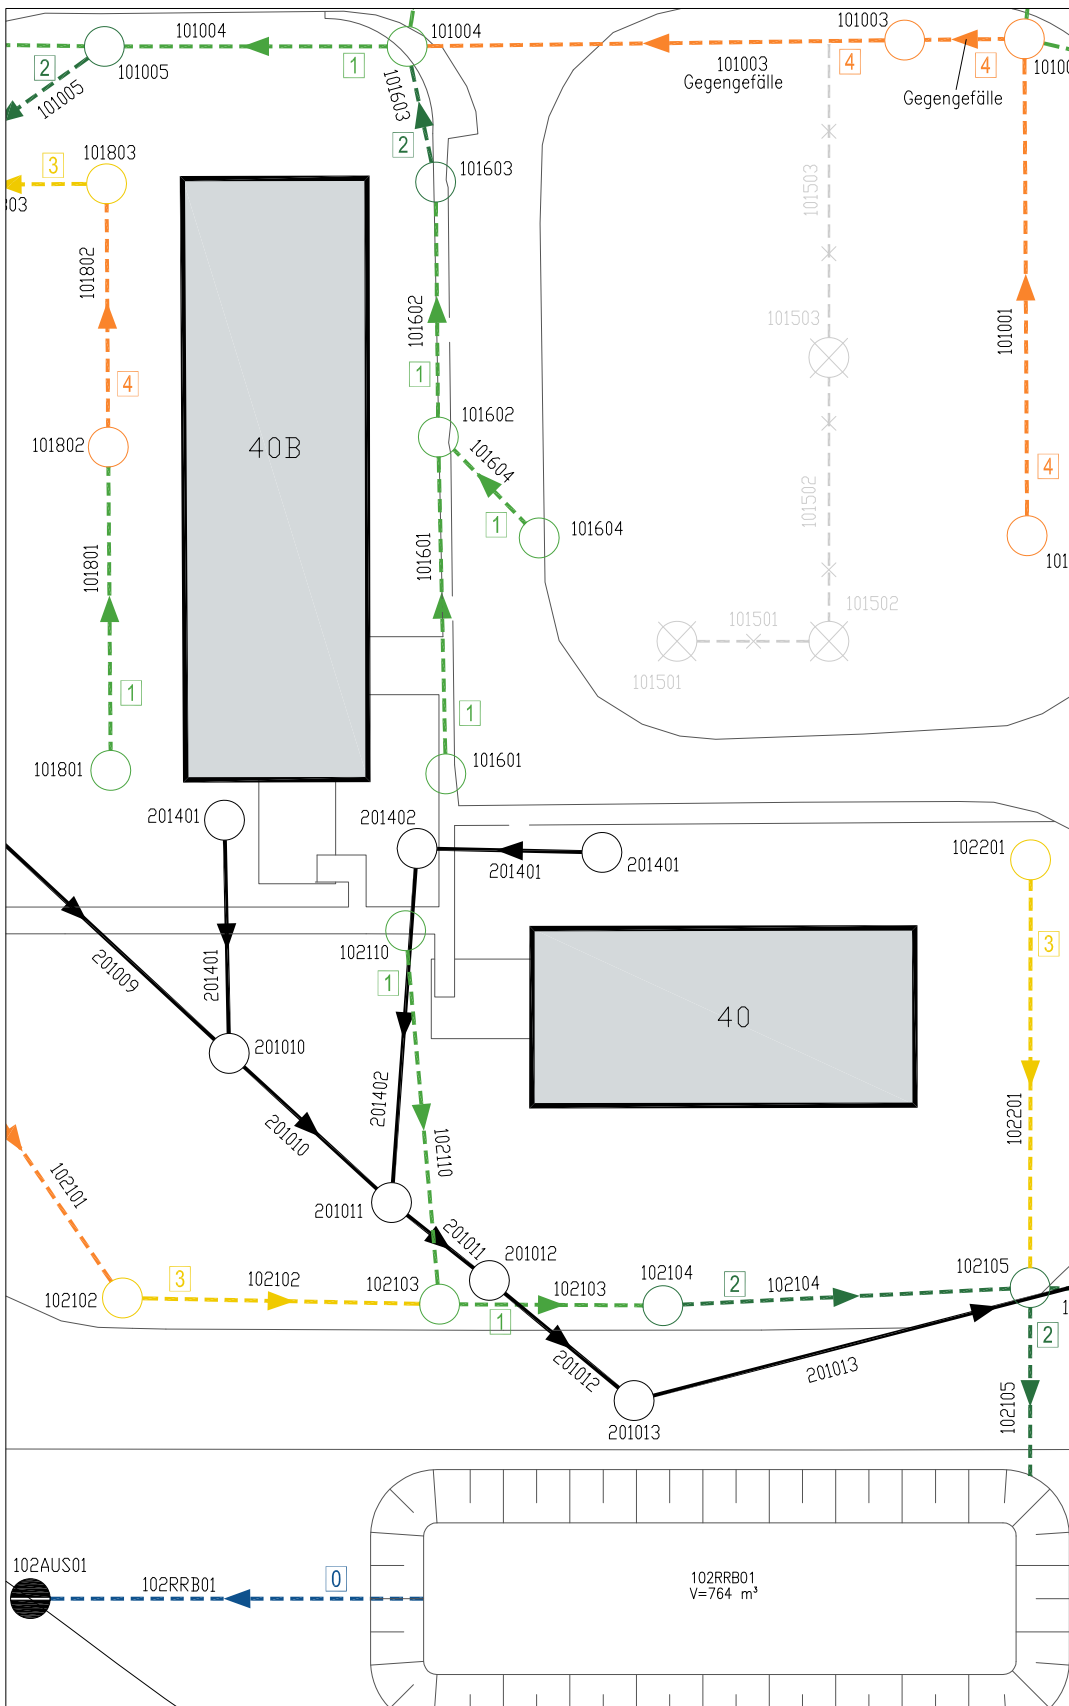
10 Beispielplan: Lageplan „Hydraulische Zustandsklassifizierung“
